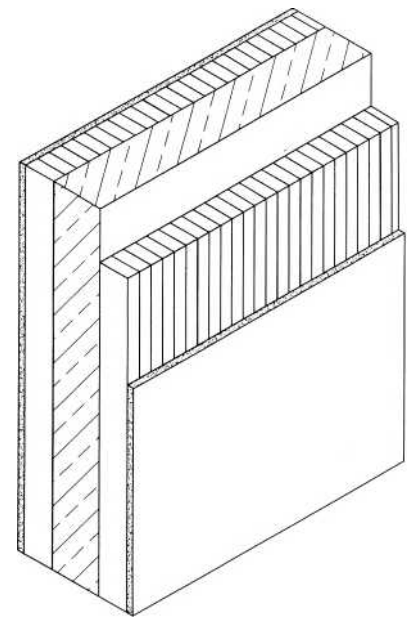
Holz-Beton-Verbundwand in Brettstapelbauweise
